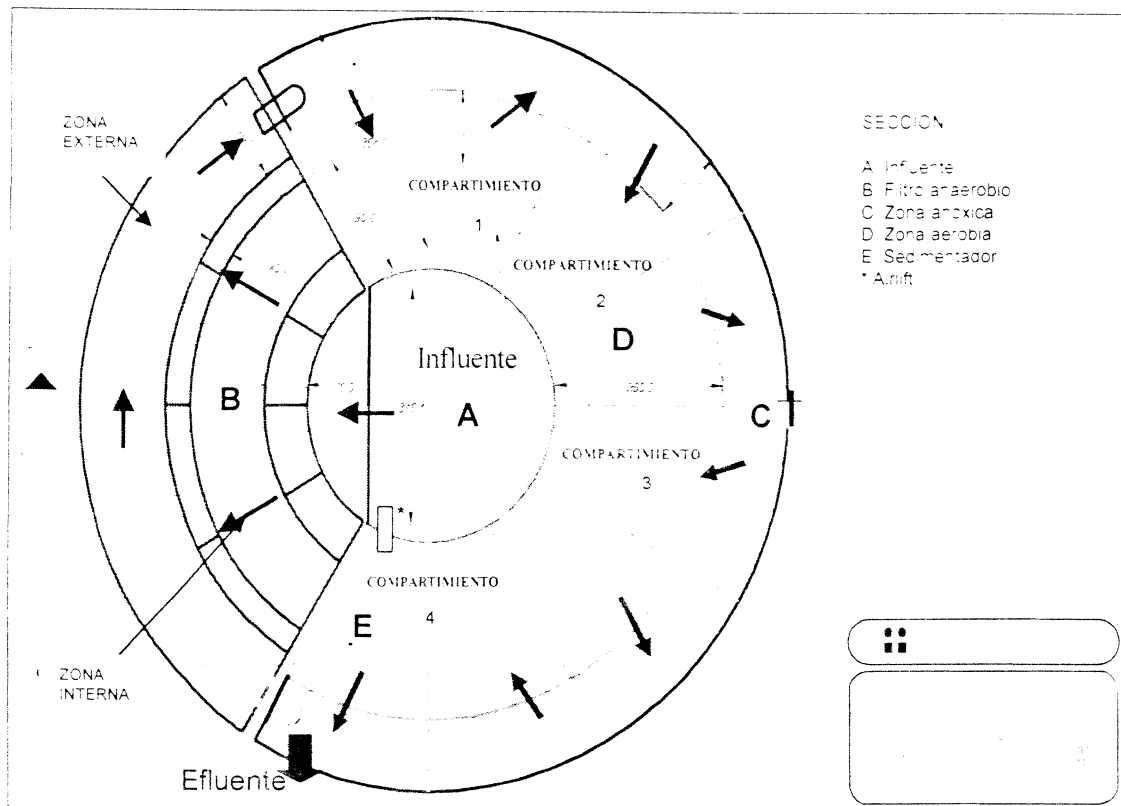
Vista de planta de las zonas que integran a la planta paquete.
